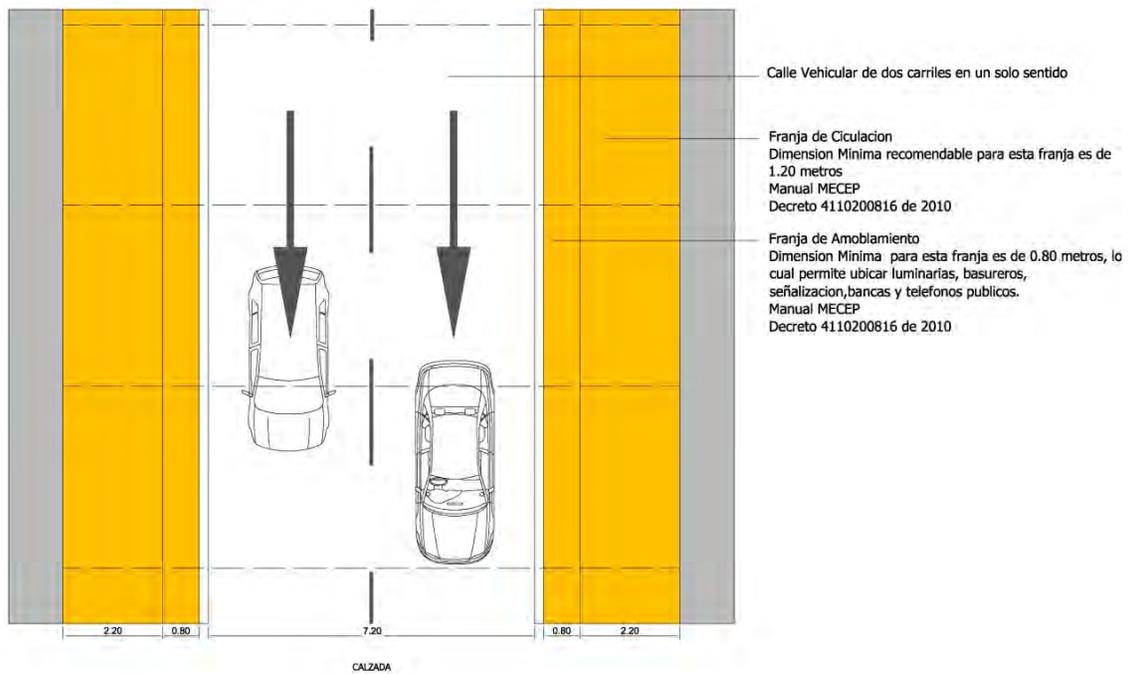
Sección Transversal de Carrera 4 y Carrera 5 entres calles 8 y 13
